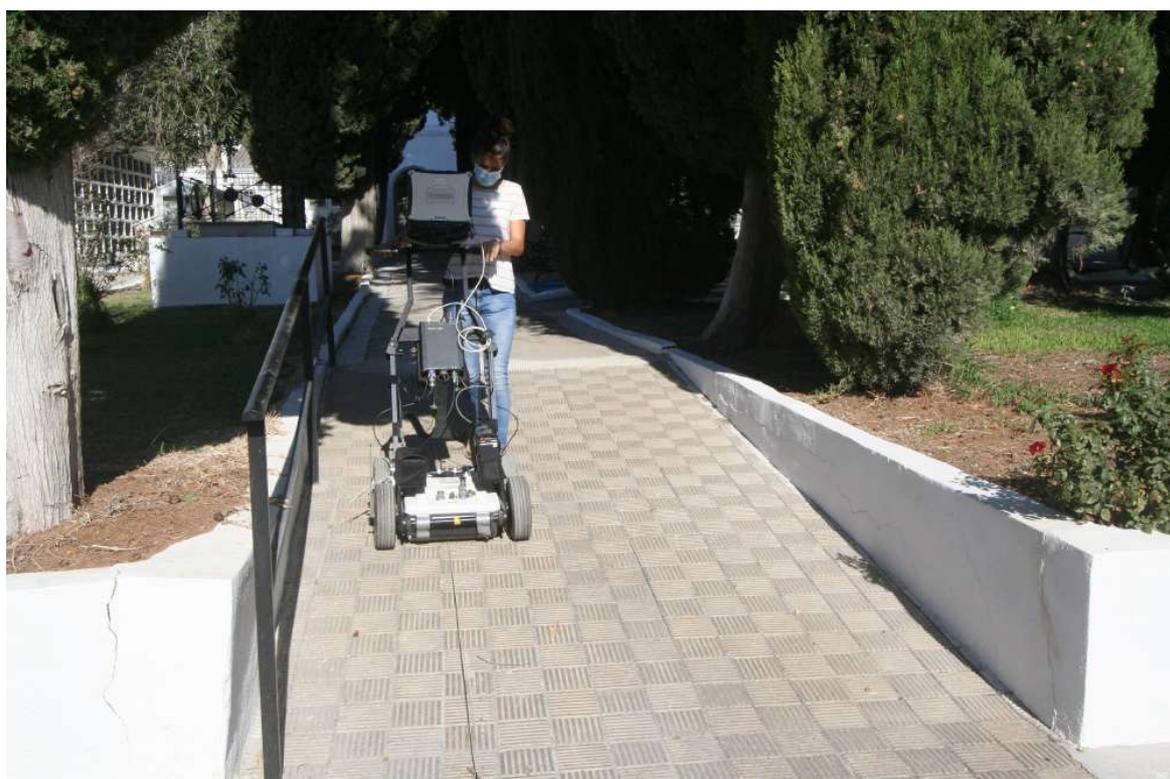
Fotografía detalle de la exploración del Proyecto 02
